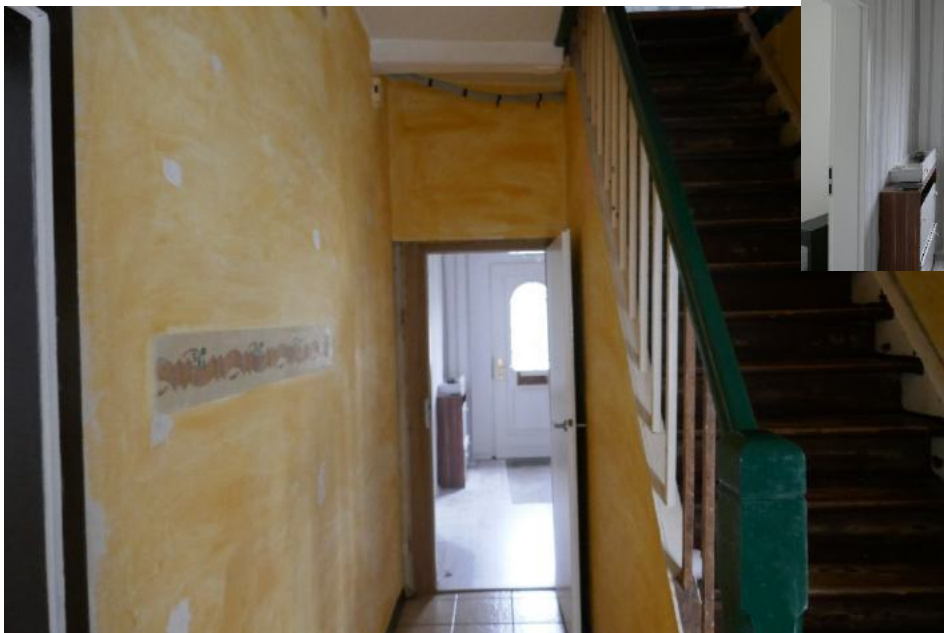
, Erdgeschoss (EG), Flur mit Treppe zum ausgebauten Dachgeschoss, kleines Foto Hauseingangstür
